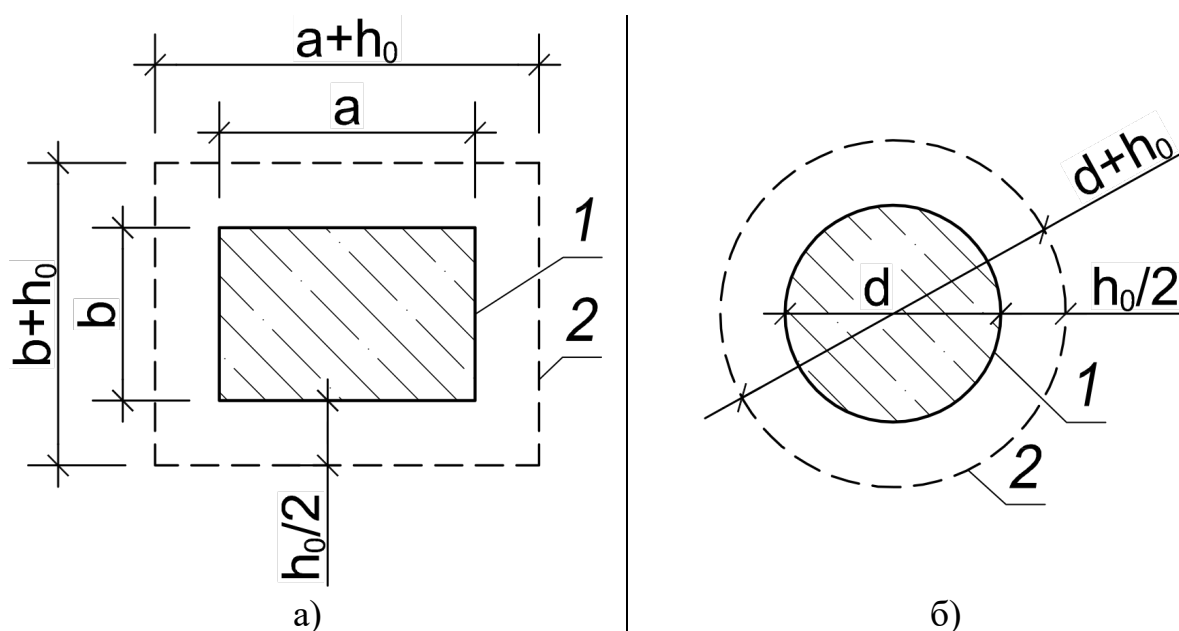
Опираение на колонну прямоугольного (а) и круглого (б) сечения: 1 – поперечное сечение колонны; 2 – контур продавливания; а, б – габариты прямоугольной колонны; d – диаметр круглой колонны
